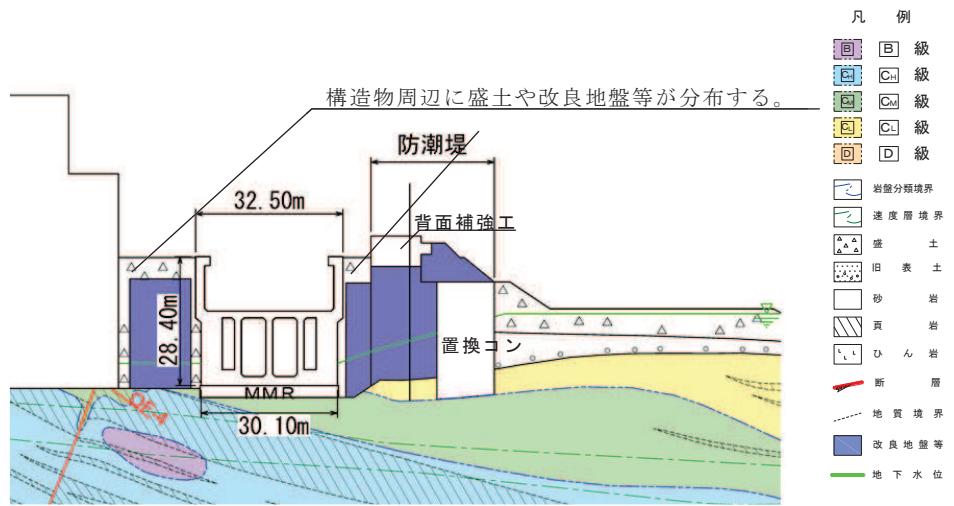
(参考例) パターン 1: 海水ポンプ室の例
